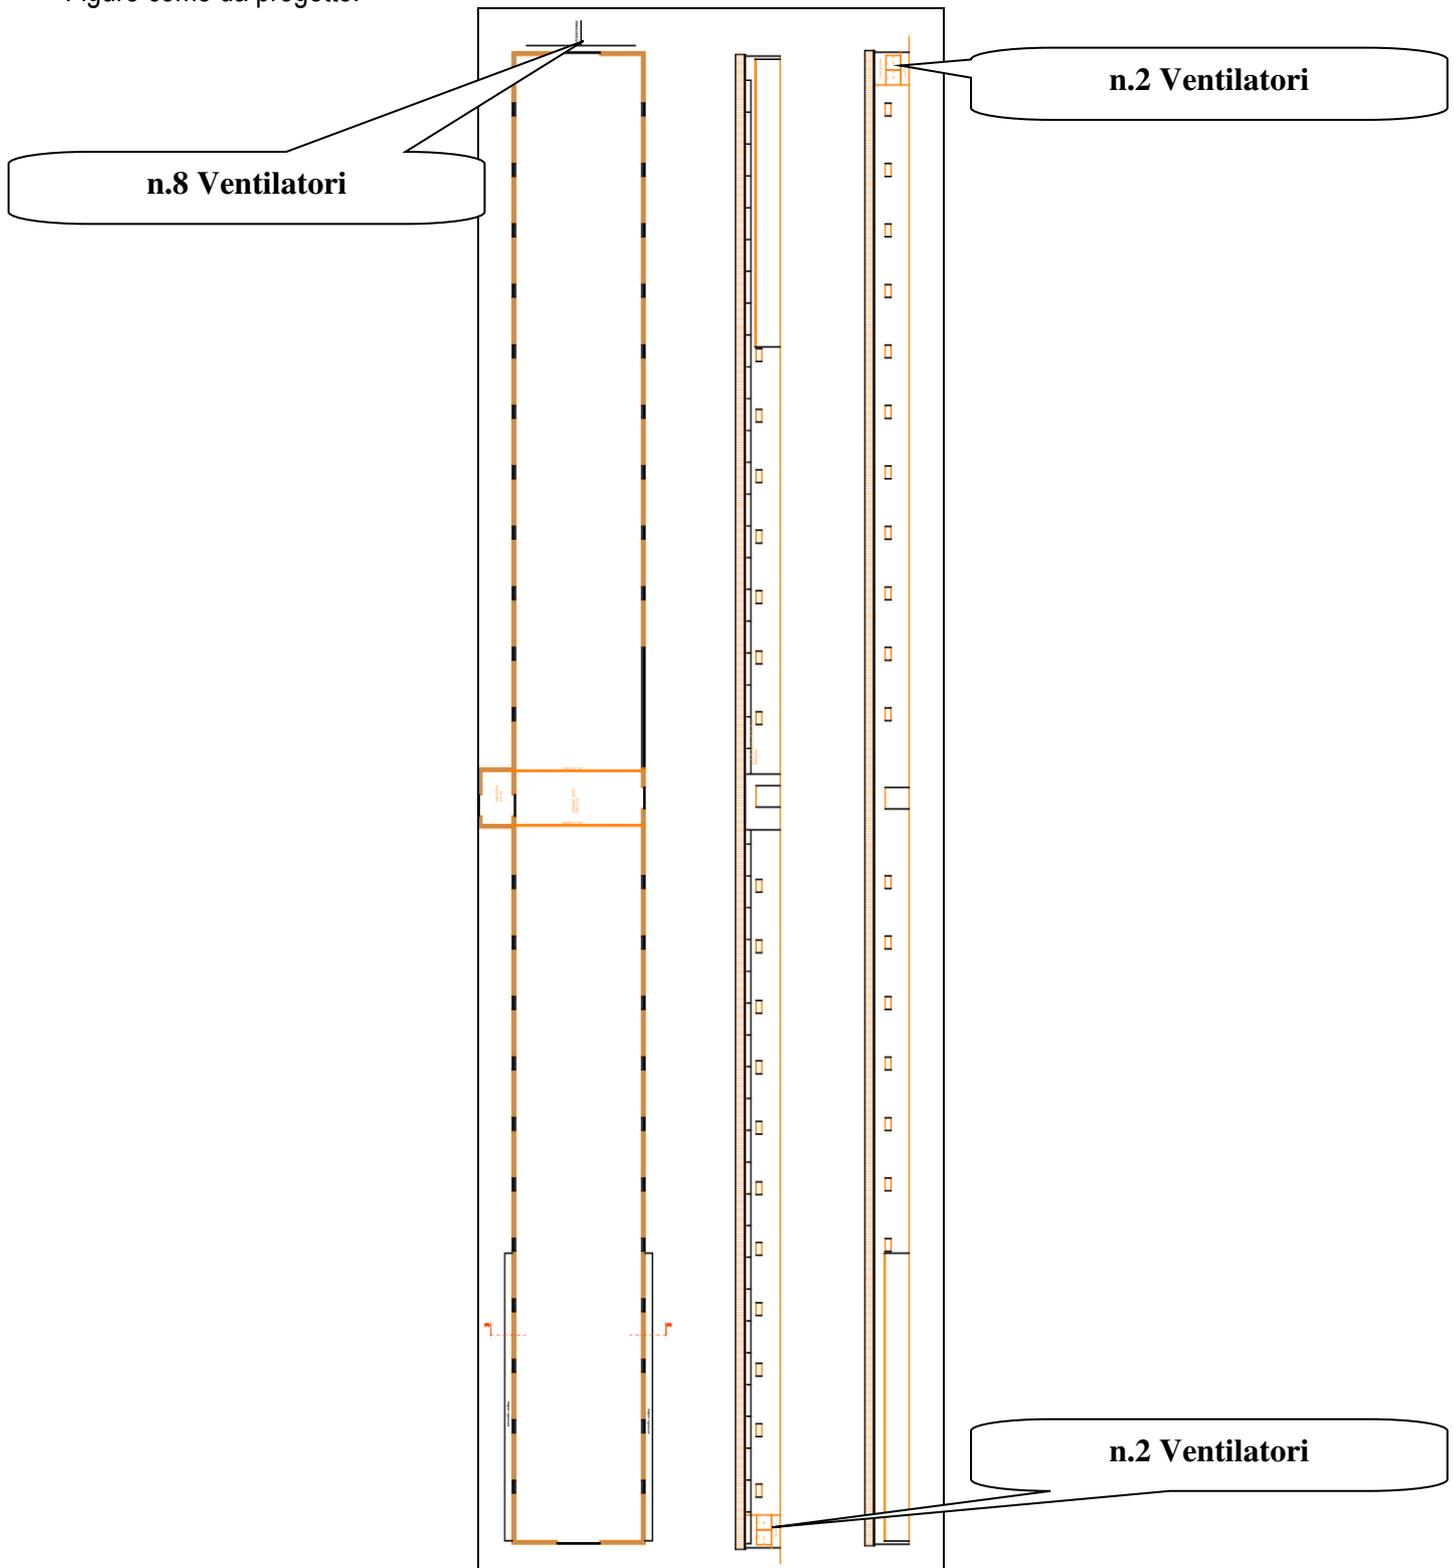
Pianta e prospetti CAPANNONE A stato futuro
